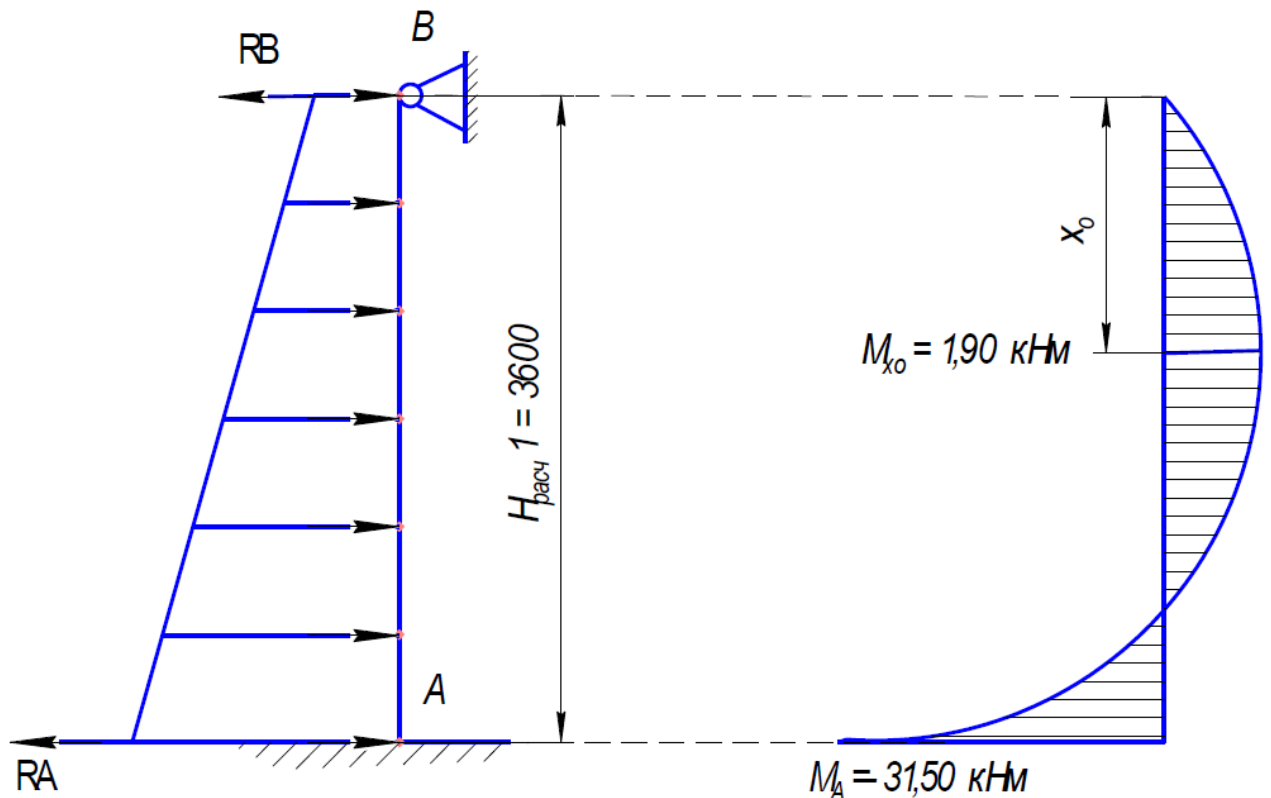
Схема нагружения стенки резервуара от грунта снаружи
